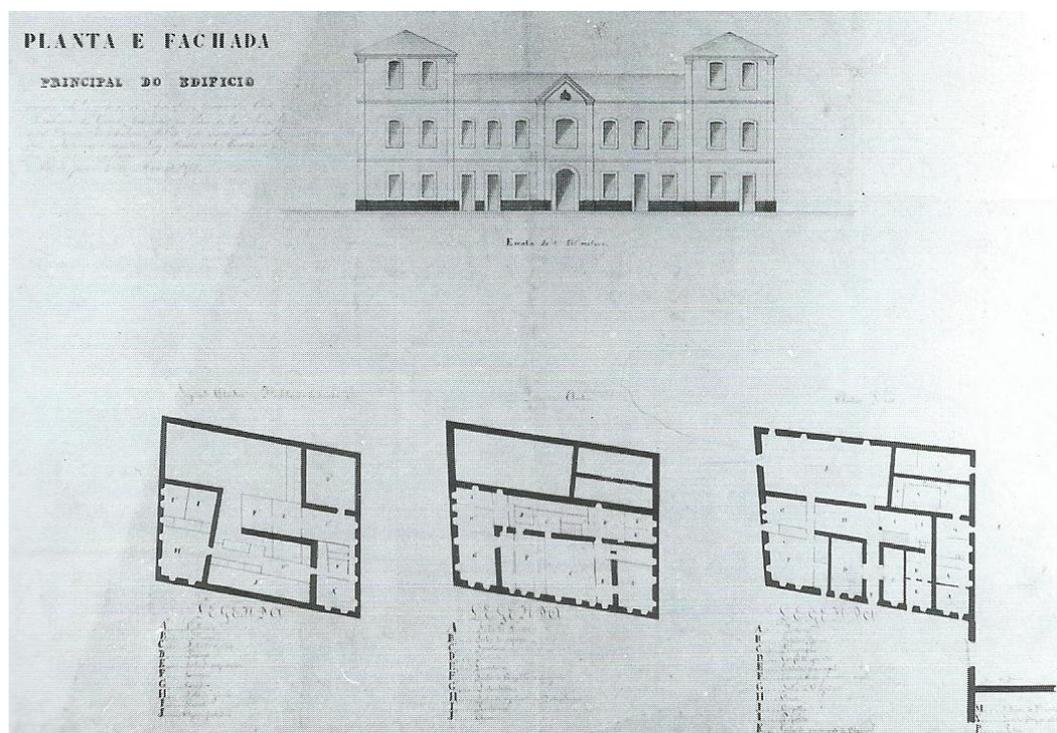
Planta e fachada do Edifício da Casa do Trem. Fonte: CDoc-AGR PM-Fot 014<sup>6</sup>
